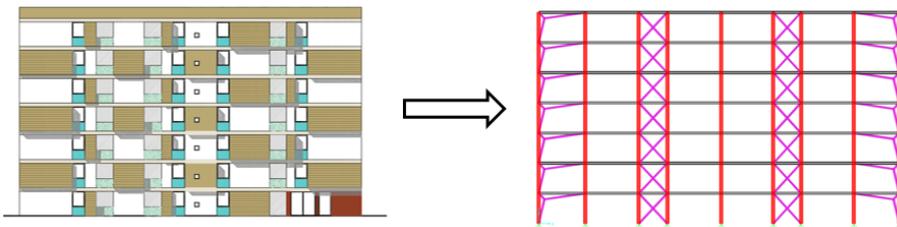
Passaggio dalla costruzione reale ad un modello di struttura intelaiata in acciaio.
